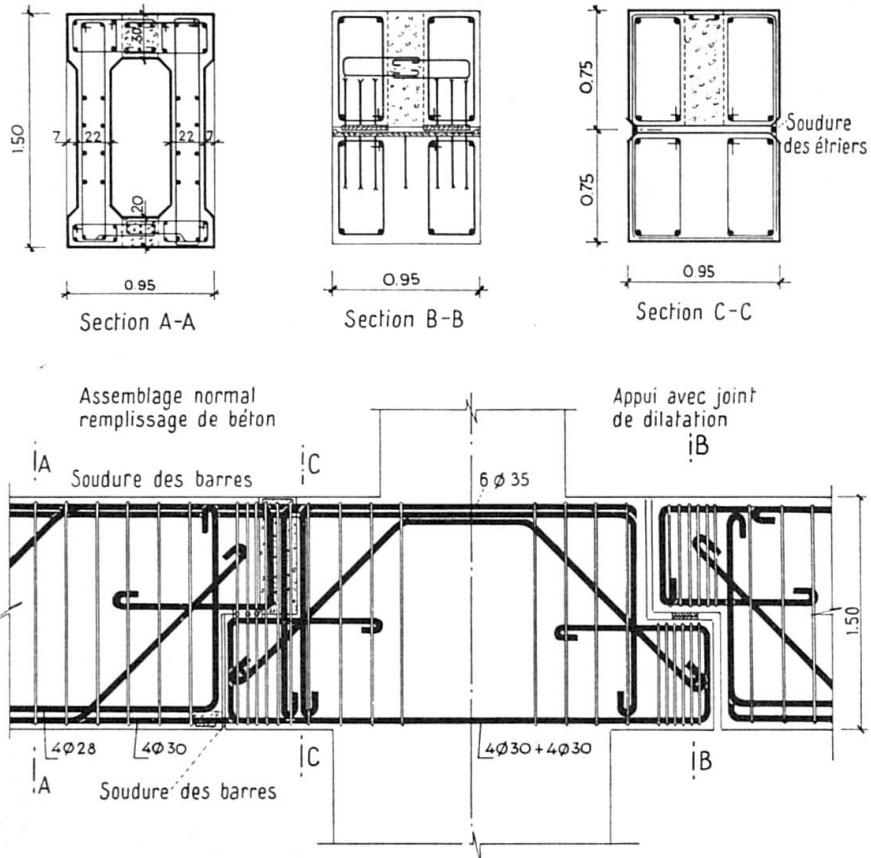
Assemblage de poutres préfabriquées avec des consoles coulées sur place — *Ensidesa* (Avilés).
